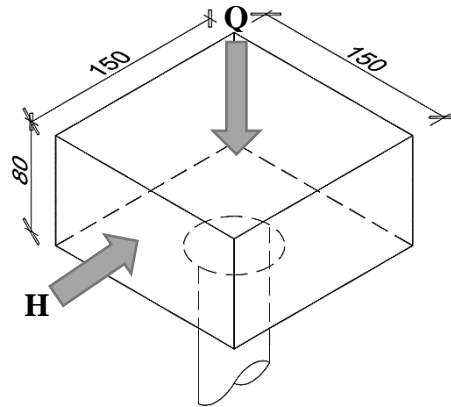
Pemodelan pondasi tiang 3D MEH
